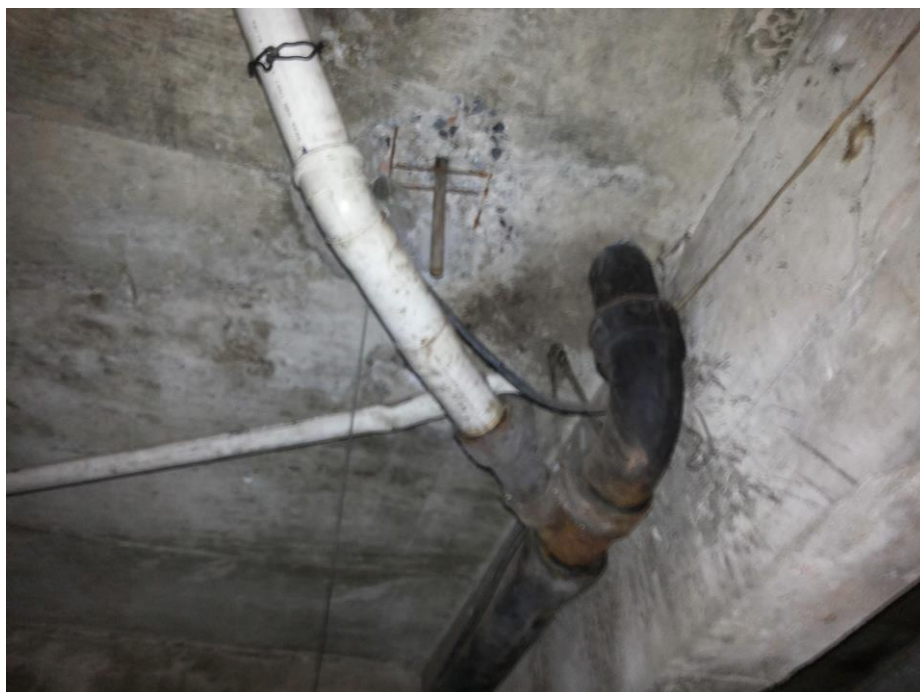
1º Subsolo. Laje deteriorada. Corrosão do concreto.
